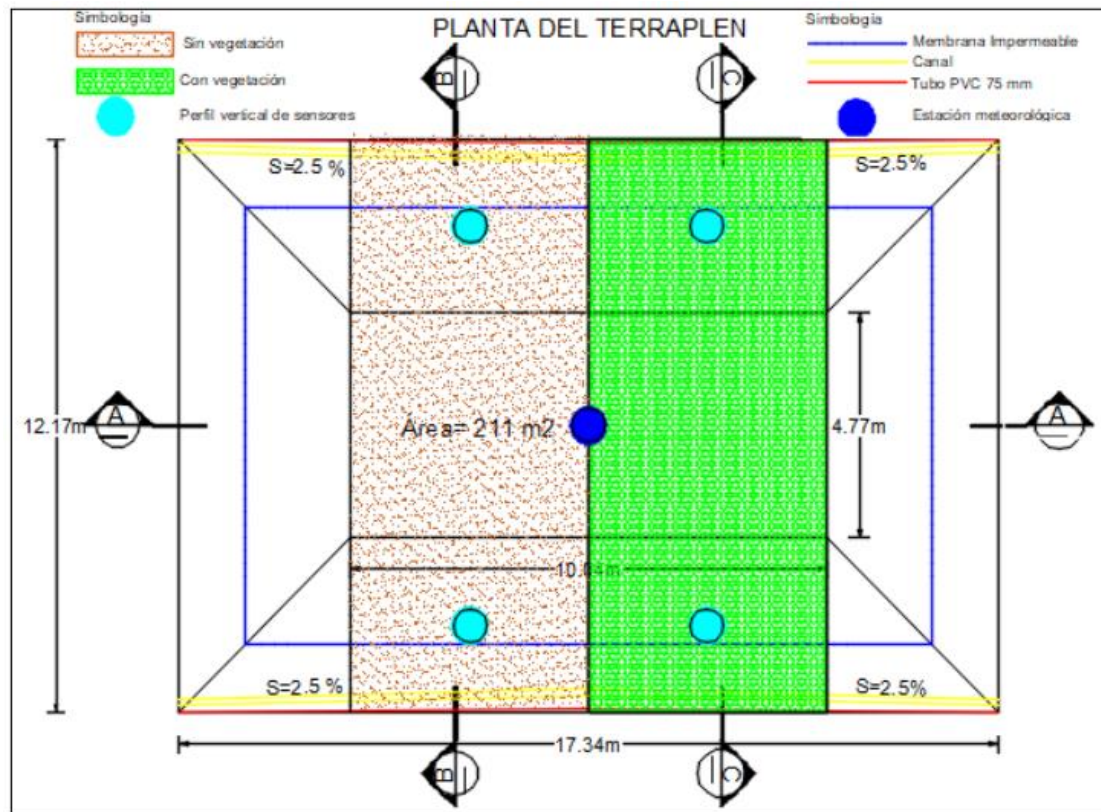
Detalle en planta de la instrumentación y características del terraplén (Guachizaca Contenido, 2018)
